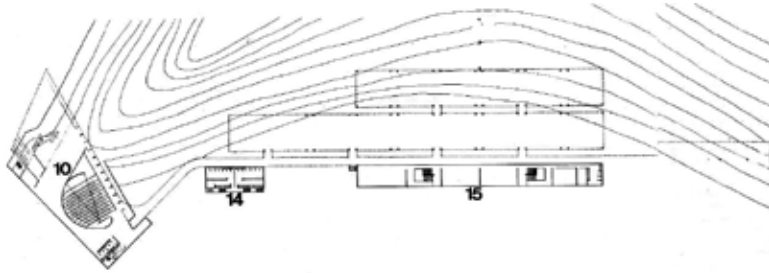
1º prêmio sede Terrafoto: planta nível 810,00: 10) anfiteatro; 14) vestiários; 15) centrais de infra-estrutura.
